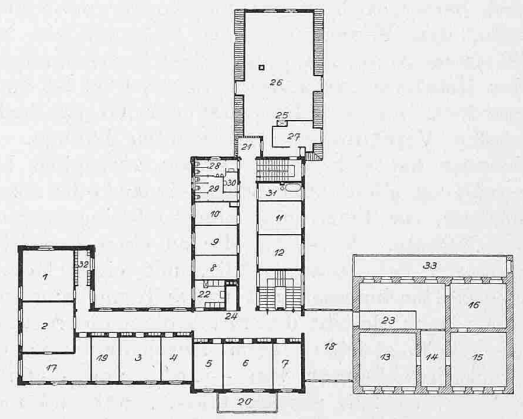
Obergeschoss-Grundriss. — Masstab 1 : 800.
